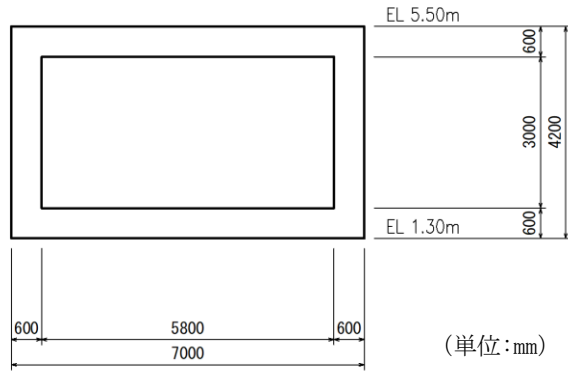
屋外配管ダクト (タービン建物～放水槽) 断面図 (A-A 断面)
